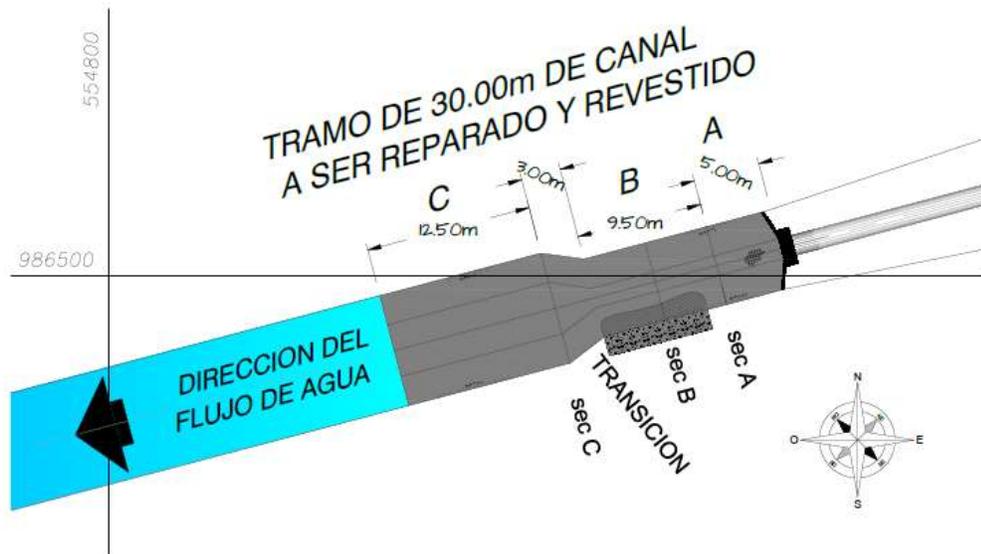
Detalle de secciones transversales para canal de riego. SENARA, 2021
